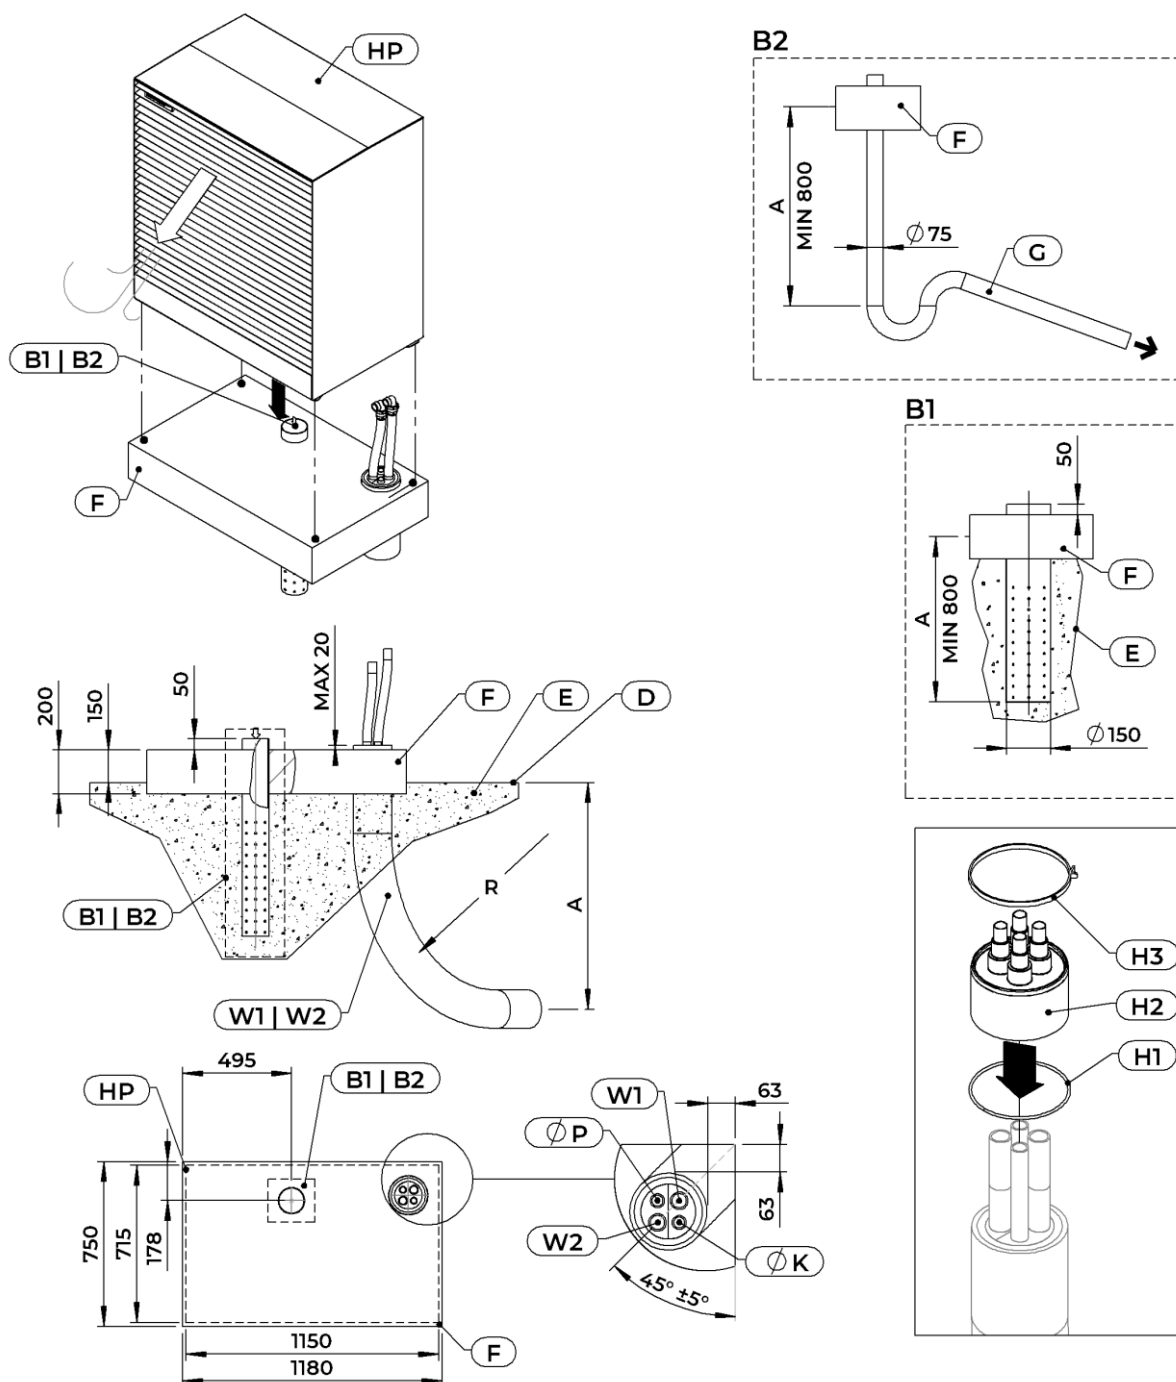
Betonfundament ADAPT 2 M, L; Rohranschluss unterirdisch
